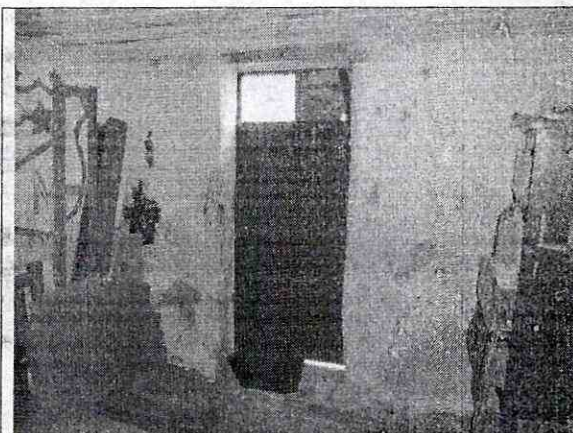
Detalle interno de la vivienda, donde se observa el avanzado estado de deterioro.
